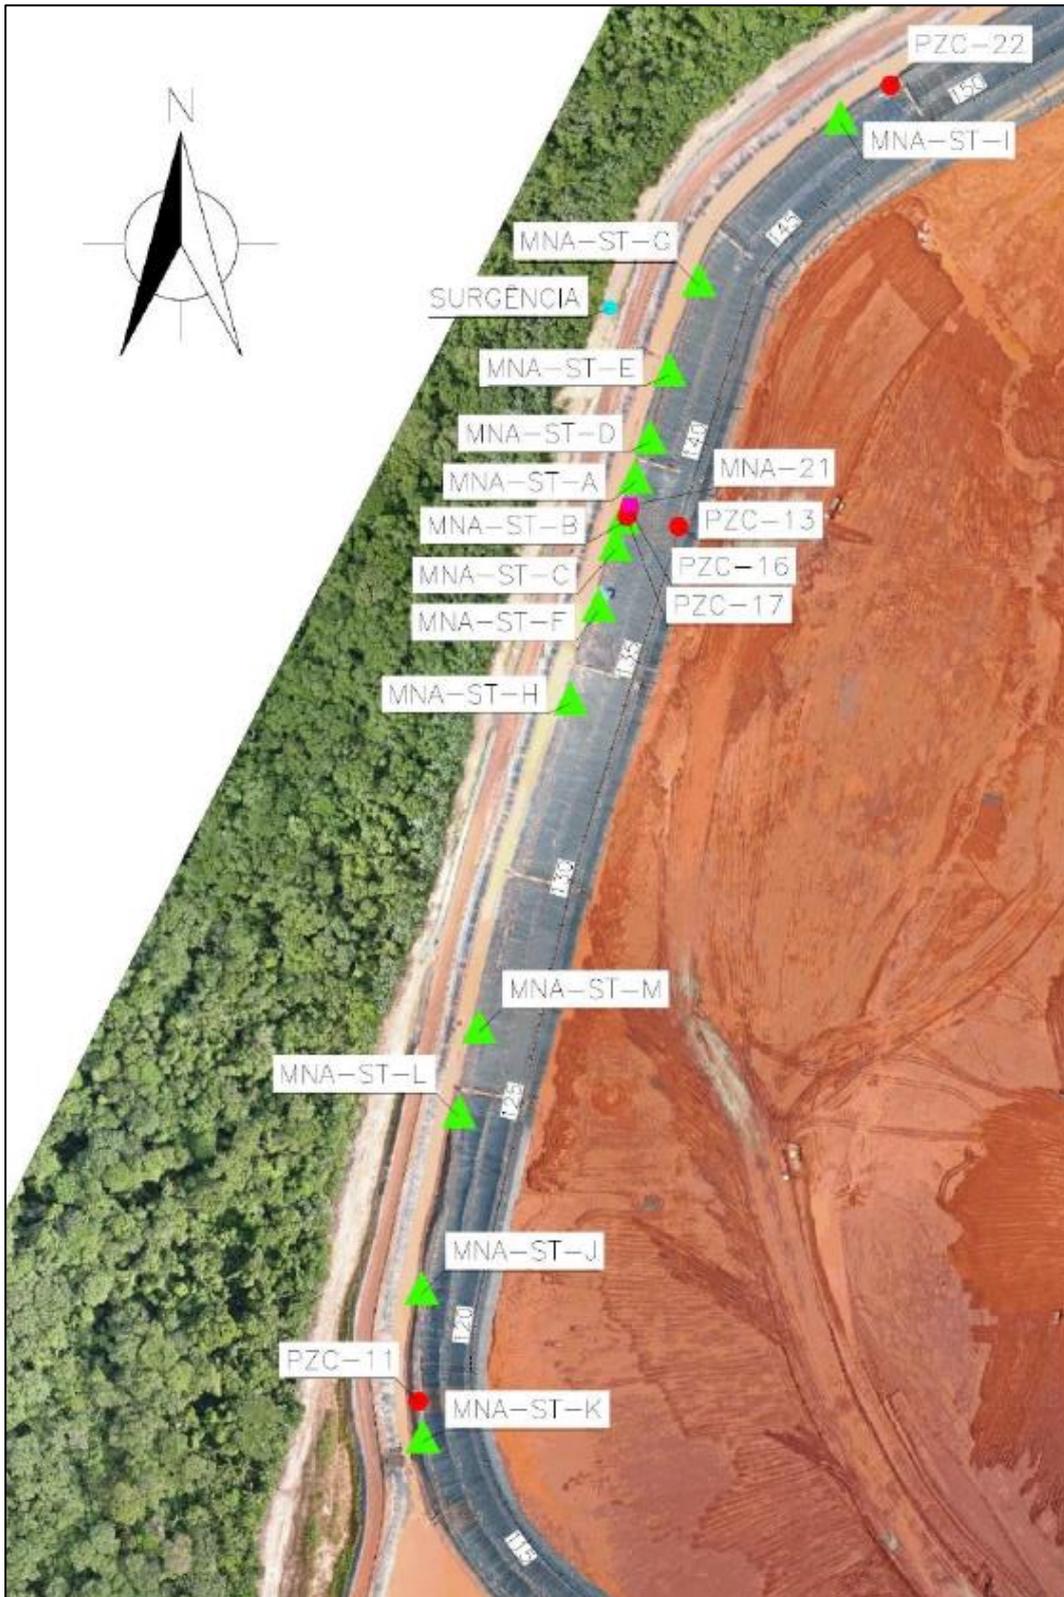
Localização em planta das sondagens a trado instalada no entorno da Seção D (PIMENTA DE AVILA, 2022)
